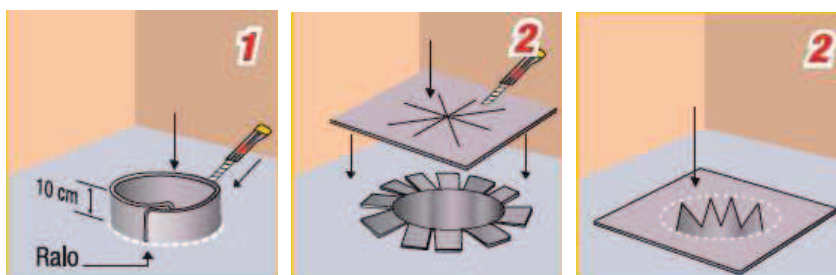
Detalhe da execução do reforço da impermeabilização dos ralos
